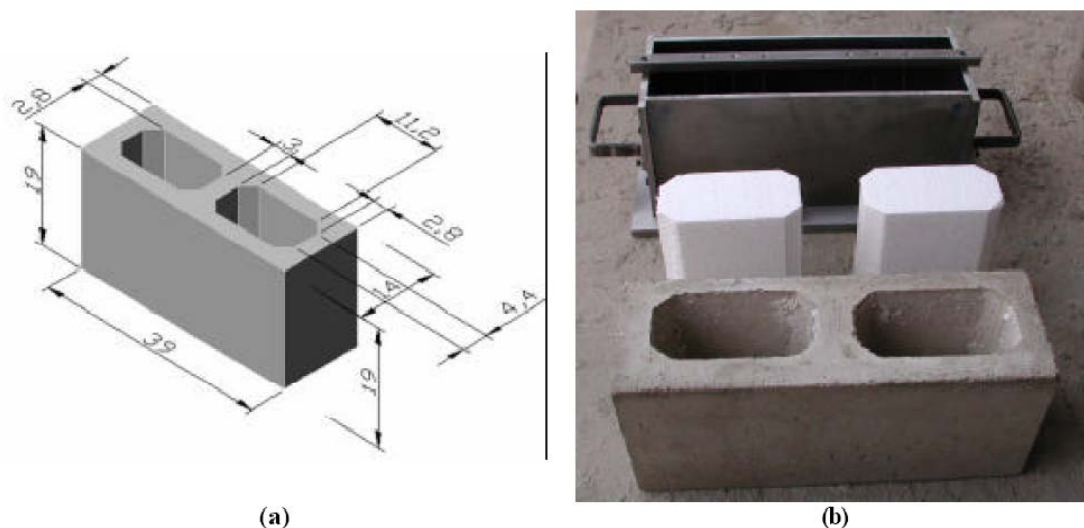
Detalhe das dimensões do bloco de betão, forma metálica e respectivos machos
